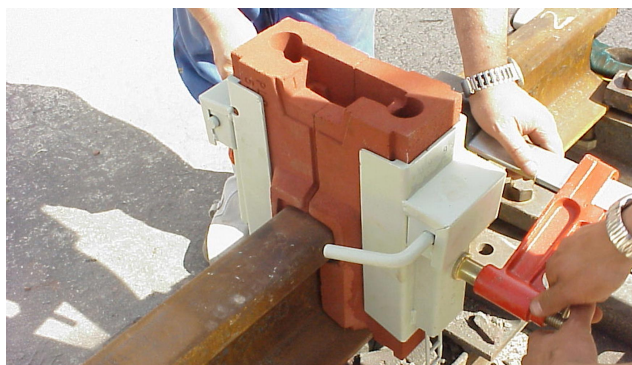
Molde para execução de soldadura aluminotérmica (Interempresas, 2017)
